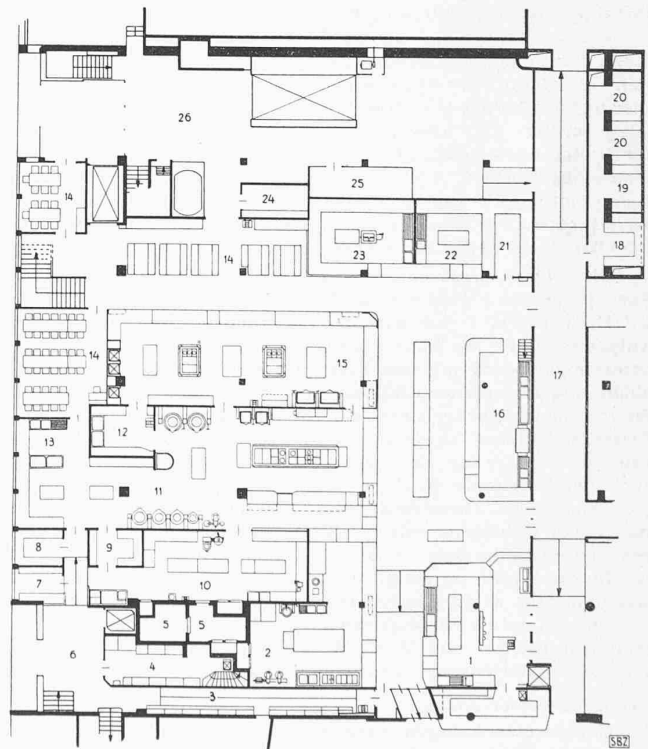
Kongresshaus-Küche, Grundriss 1:400.
